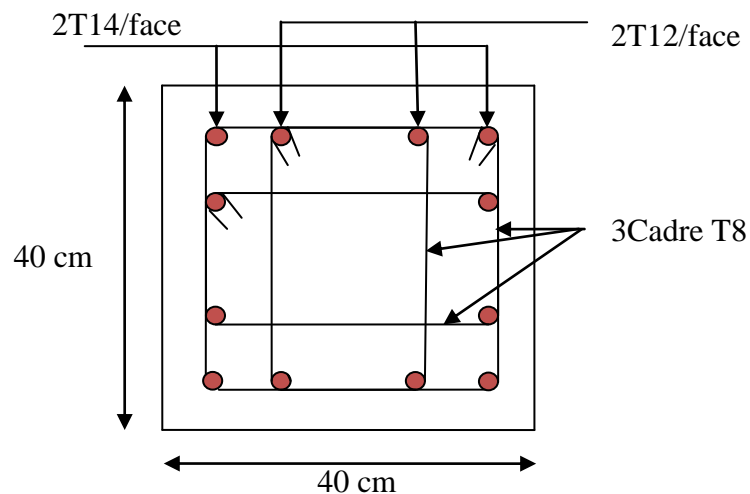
Schéma de ferrailage des poteaux de 9^{ème}, 10^{ème}
